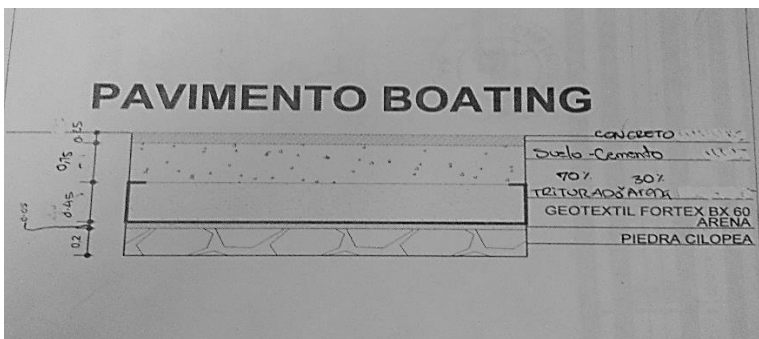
Perfil de Boating. Fuente ING. Jaime Maestre.
